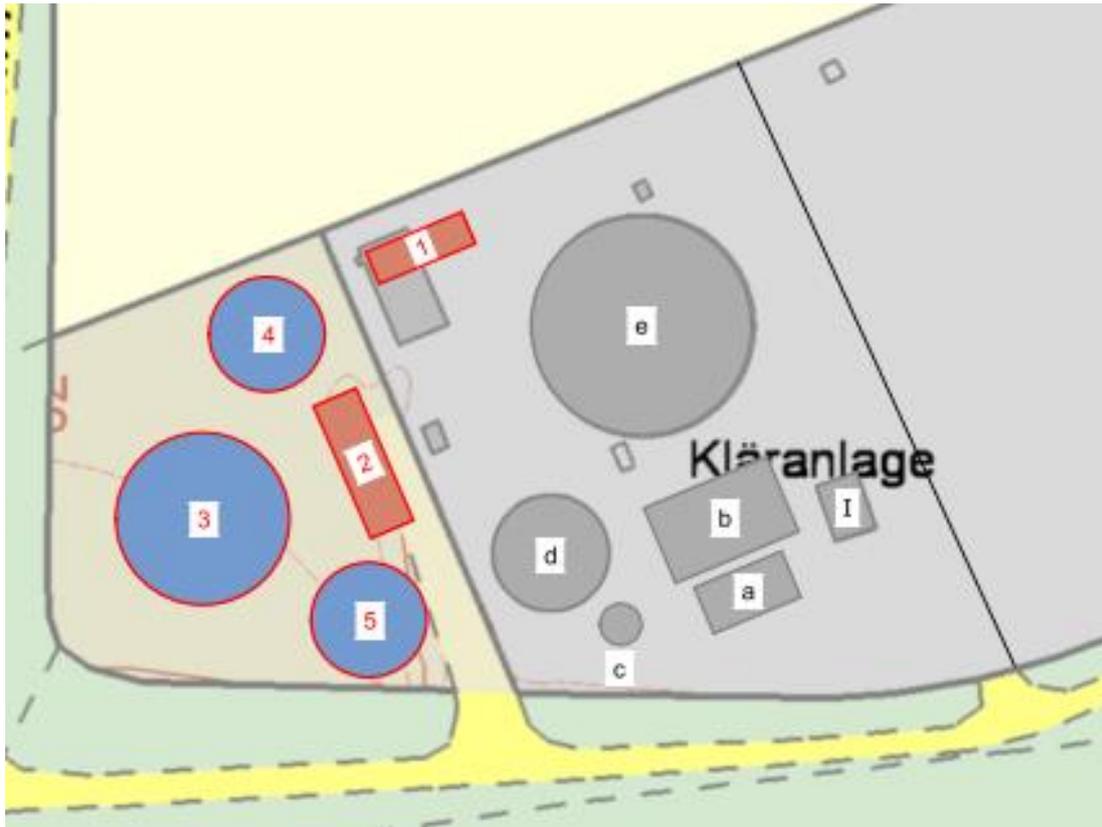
Lageplan Variante 2 / 3: Westkläranlage
